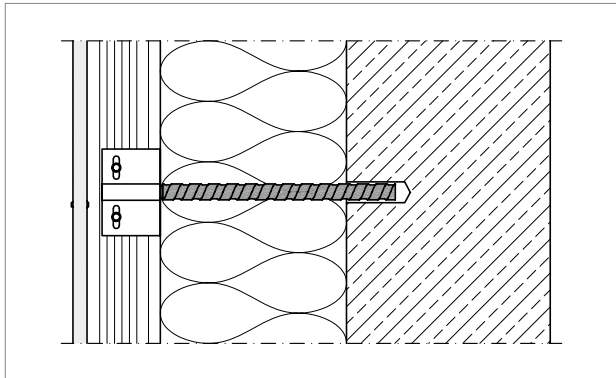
Schöck Isolink® Typ F: Verankerung im Beton
